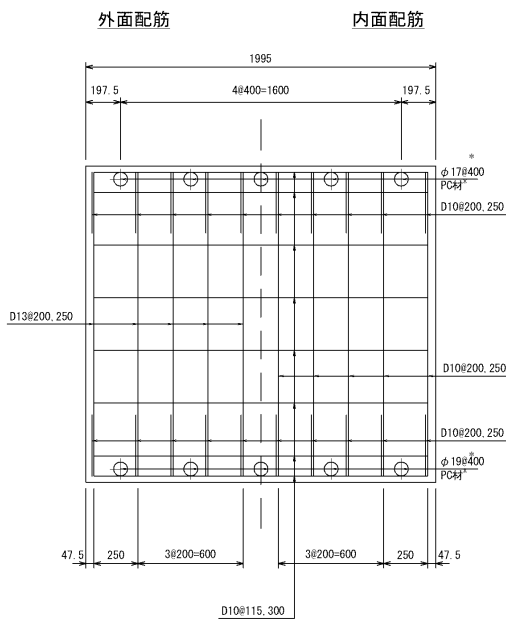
(1) 屋外排水路 (防波壁横断部) の概略配筋図
